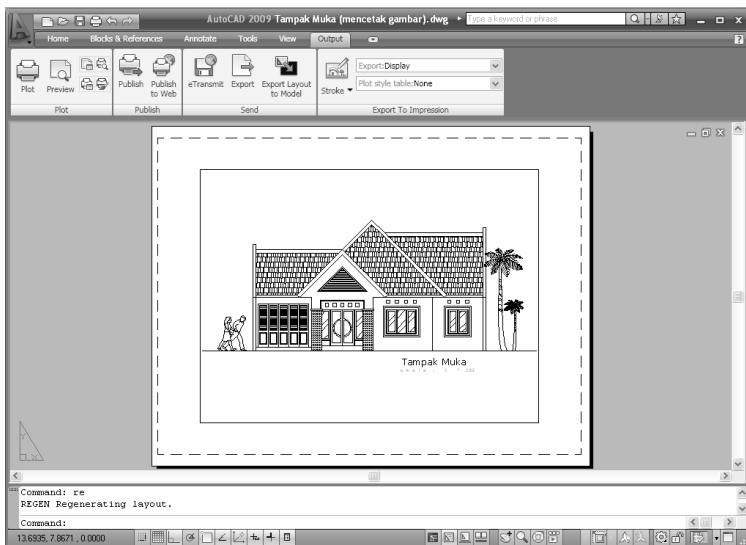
Tombol model, Layout1, dan Layout2
